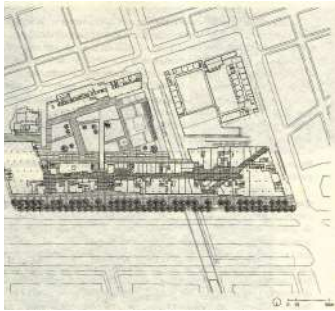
Plano de planta del proyecto original de Rafael Moneo del edificio L'Illa Diagonal.
